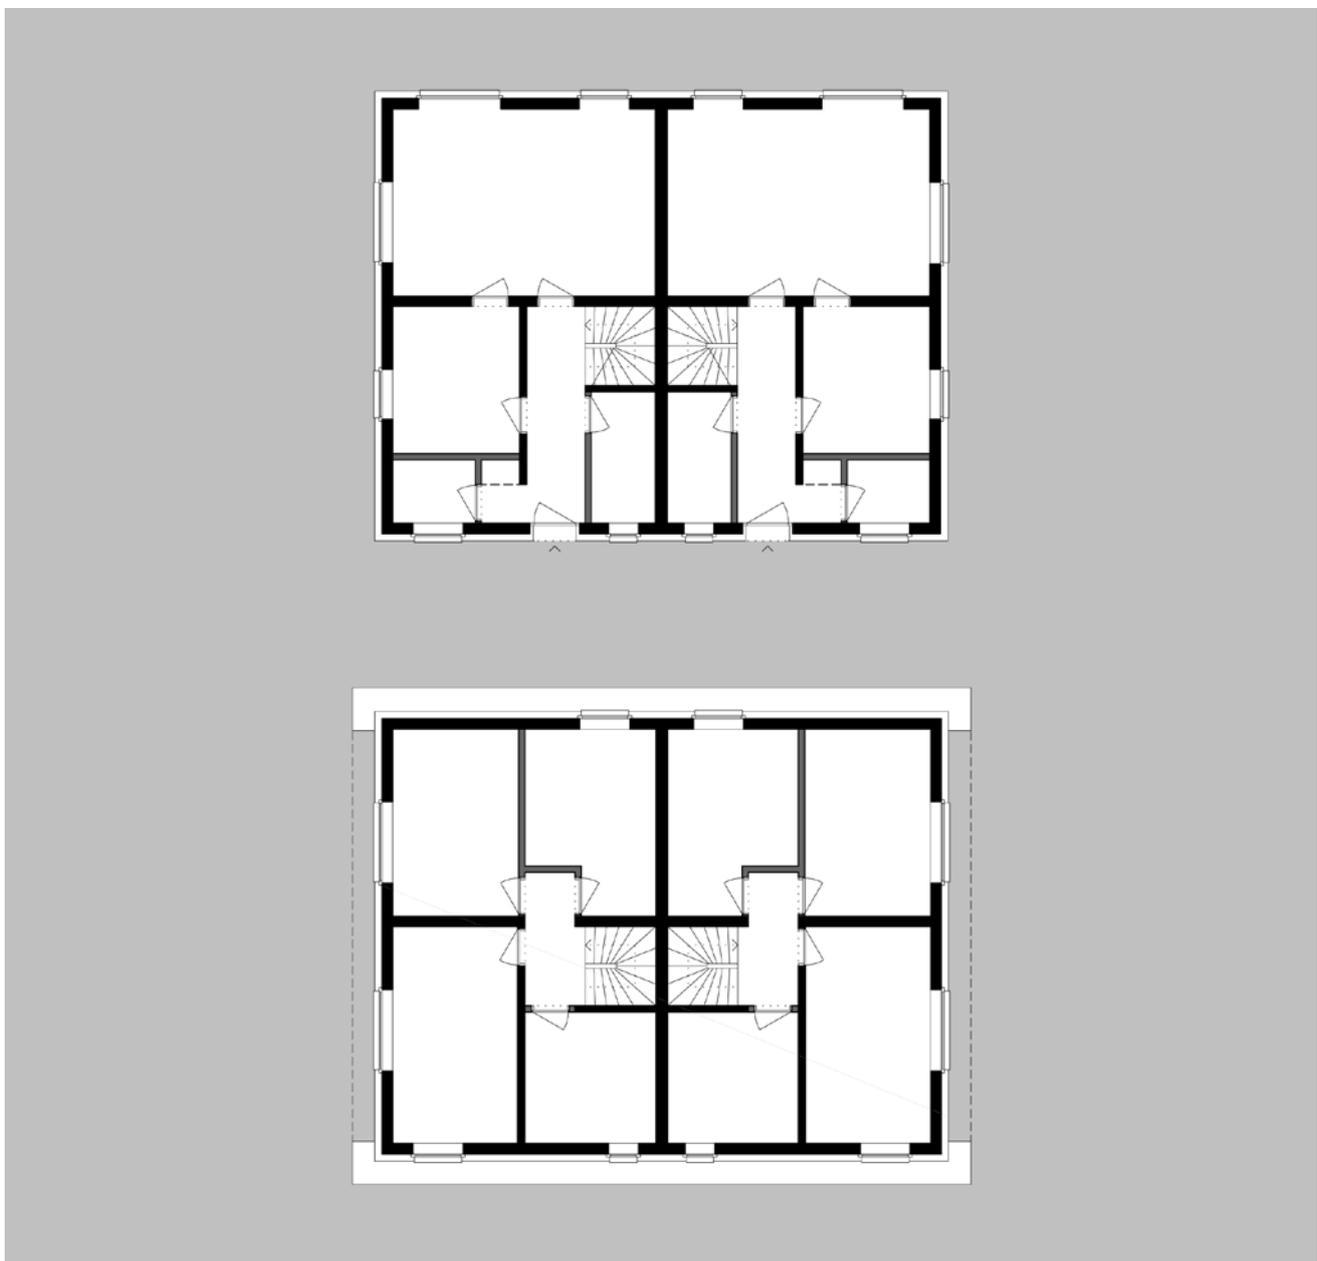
Referenzgebäude Doppelhaus (DH) mit zwei Stockwerken, dargestellt in den Grundrissen für Erdgeschoss und Obergeschoss
